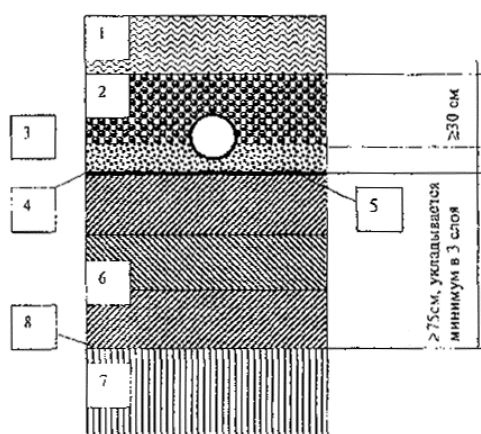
Конструкция защитного экрана основания полигона 2-го класса: 1 - свалочный грунт, 2 - дренажный слой, 3 - дренажная труба, 4 - защитный слой, 5 - синтетическая гидроизоляция, 6 - минеральный изоляционный слой, 7 - геологический барьер, 8 - планировочная отметка основания карты полигона
